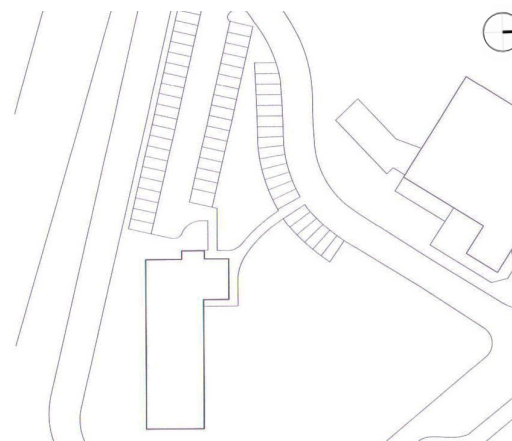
Planimetria generale; Fonte: Detail Green, 2009;
